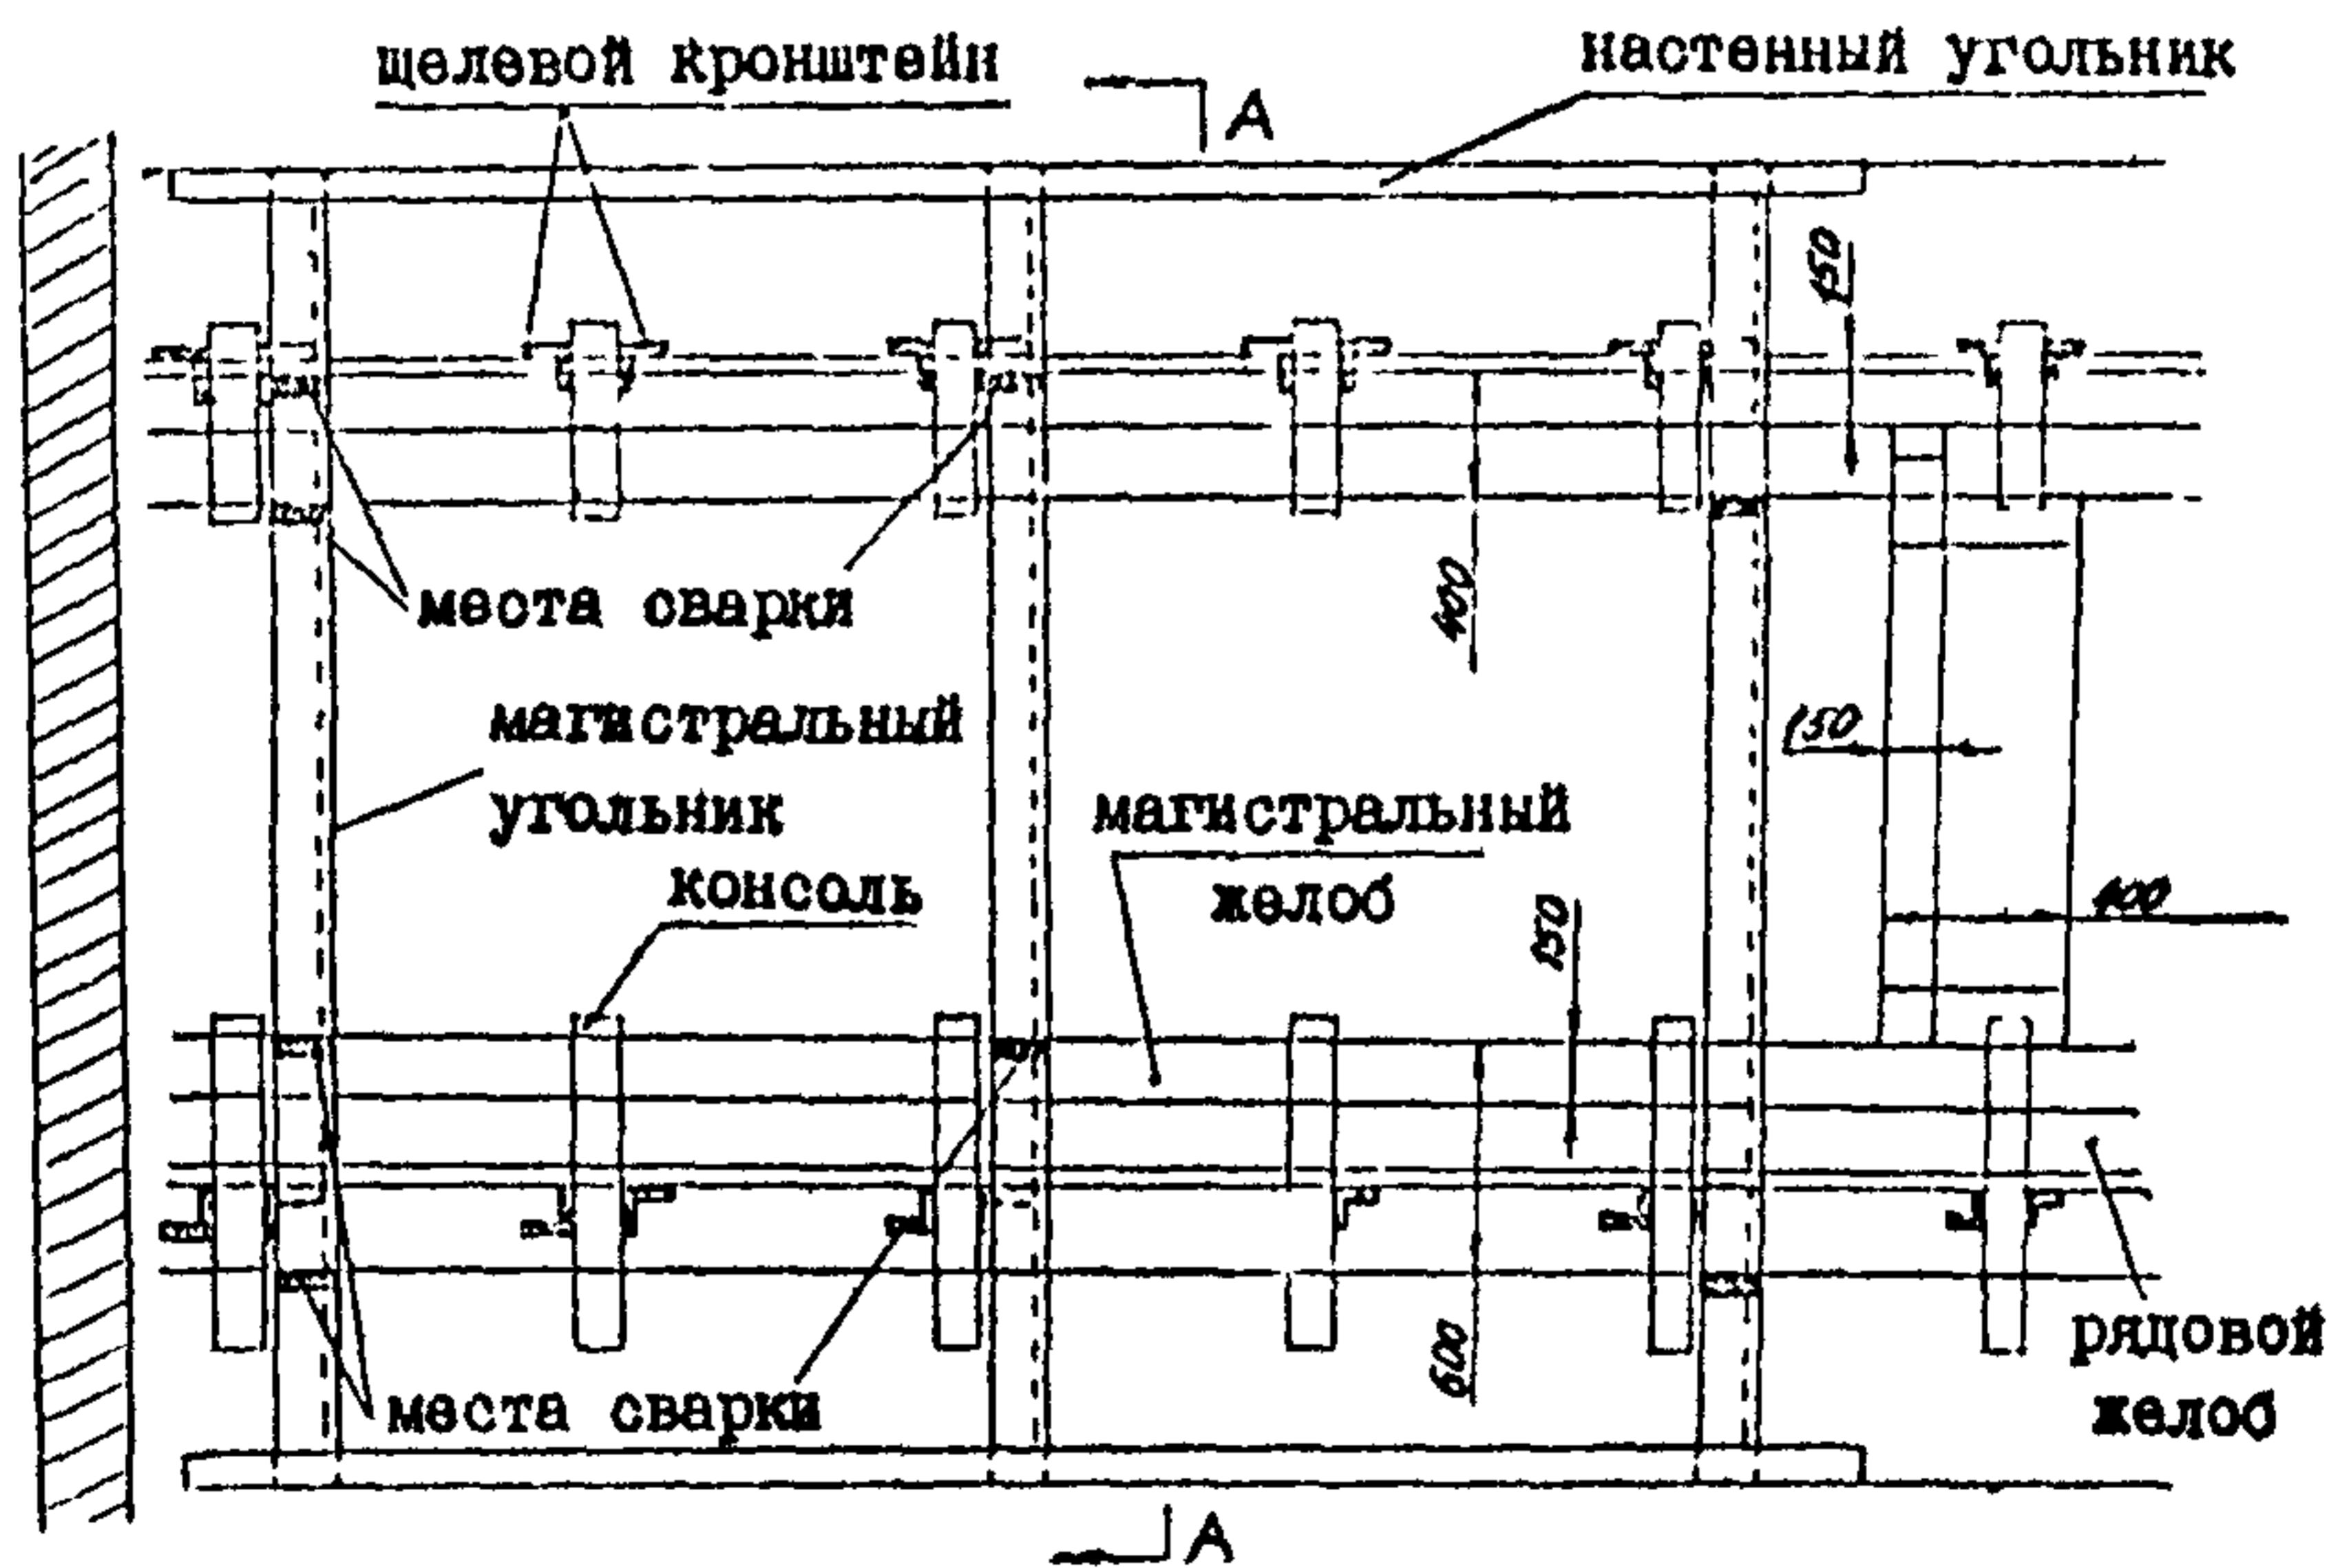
Расположение и места сварки желобов в шахте (примерное)
